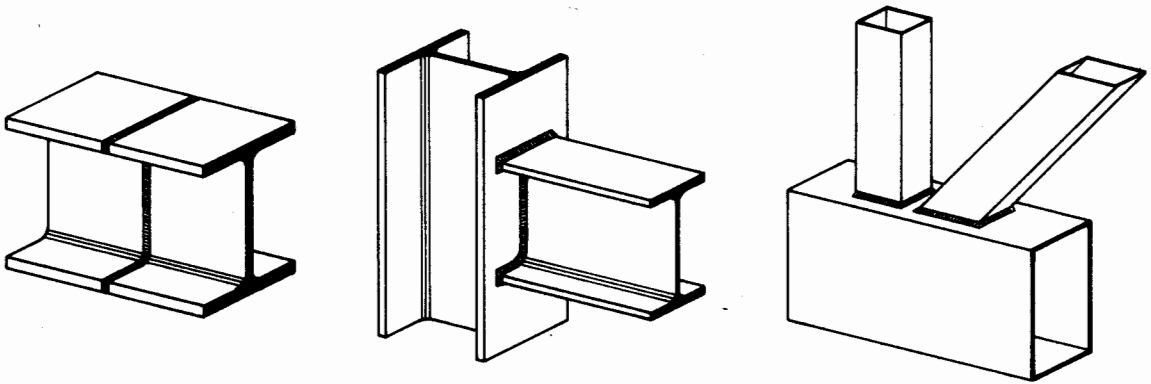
Exemples d'assemblages soudés.
